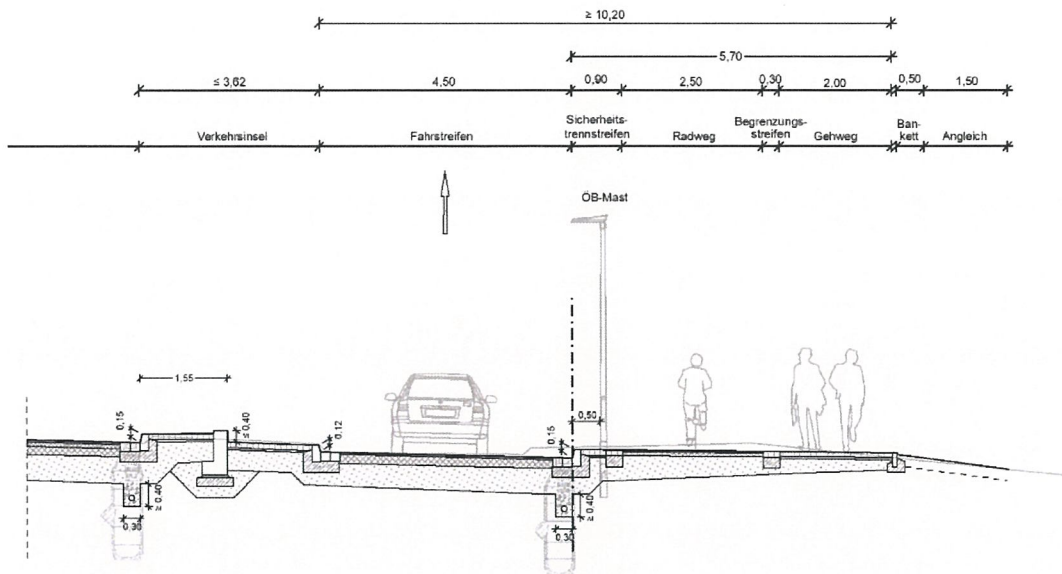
Querschnitt Oederaner Straße bis Fabrikstraße (stadteinwärtige Fahrbahn)
